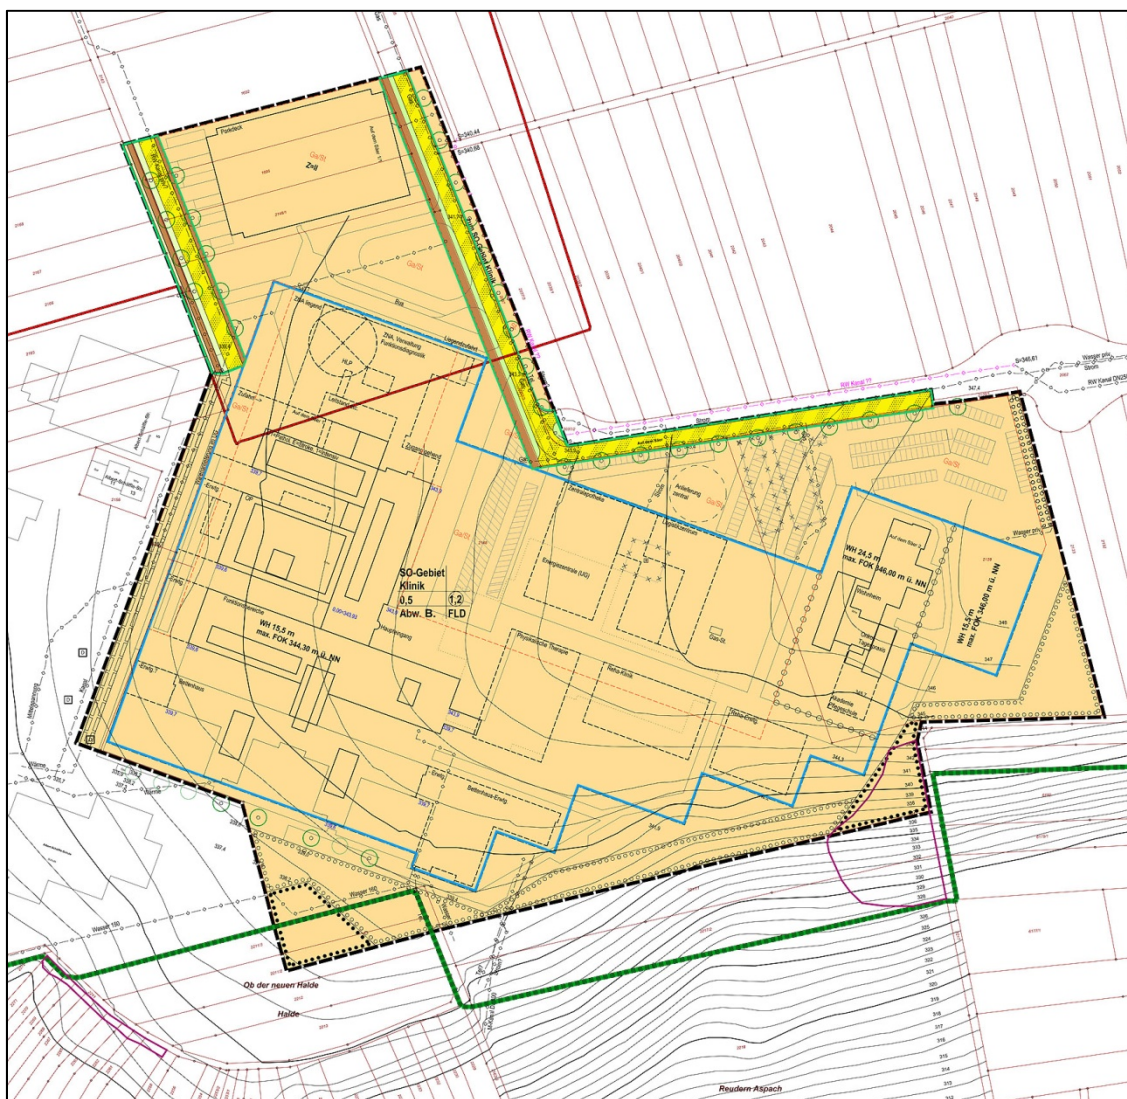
Planzeichnung zur 2. Änderung des Bebauungsplans "Sondergebiet auf dem Säer" /17/
